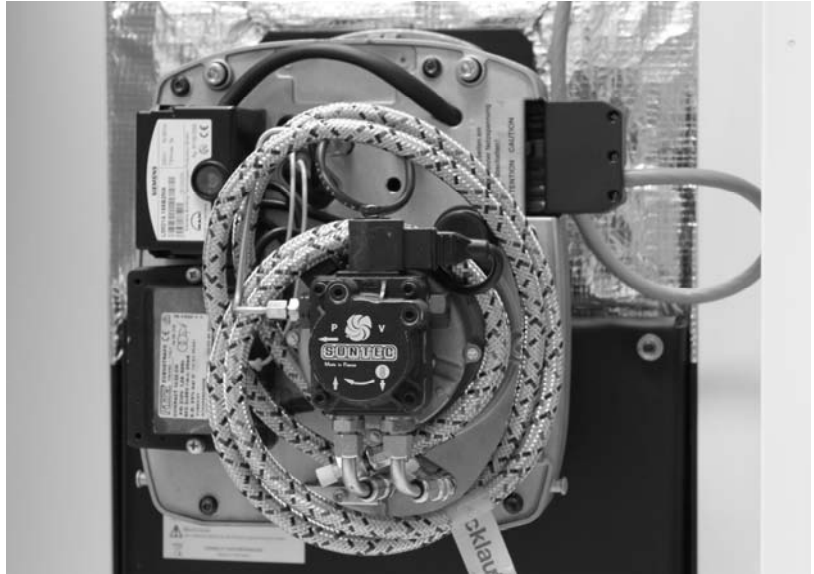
Den Brenneranschlussstecker in die Buchse des Brenners stecken.
